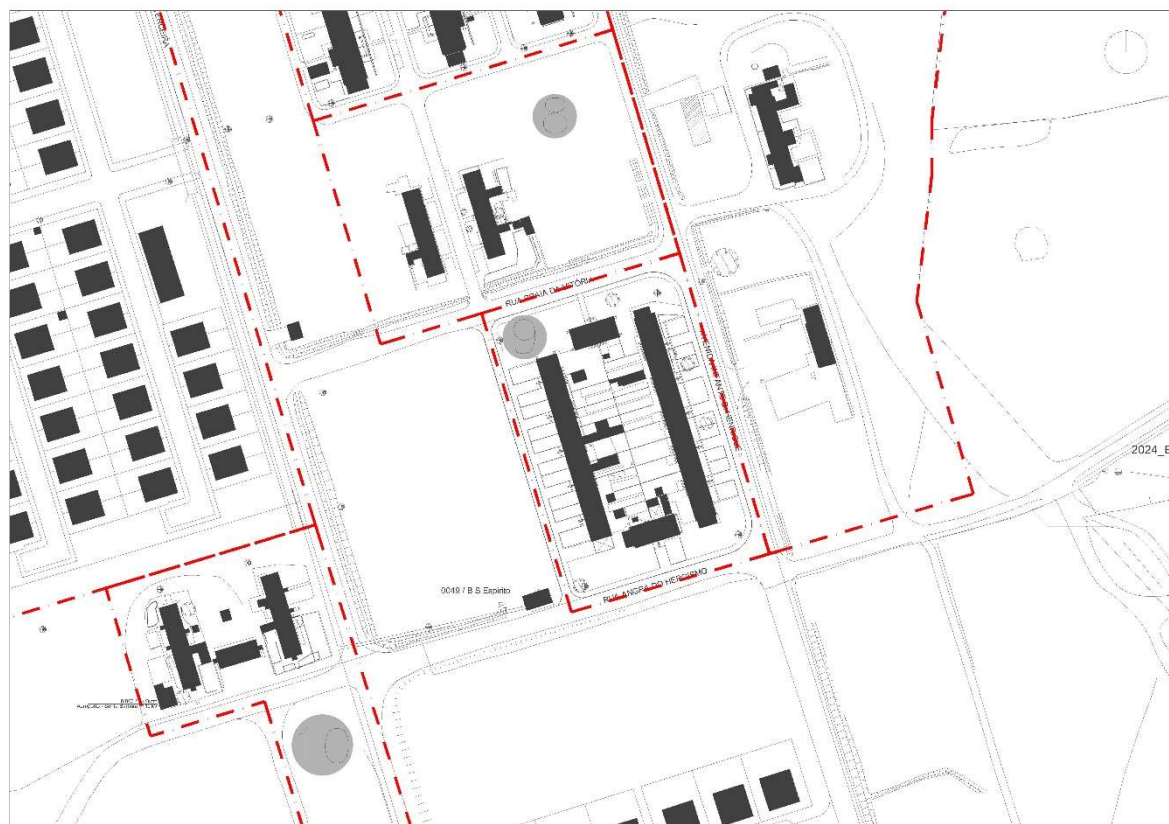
Planta do Bairro Santo Espírito (Extrato de Planta Cedida Pelas Ilhas de Valor)
